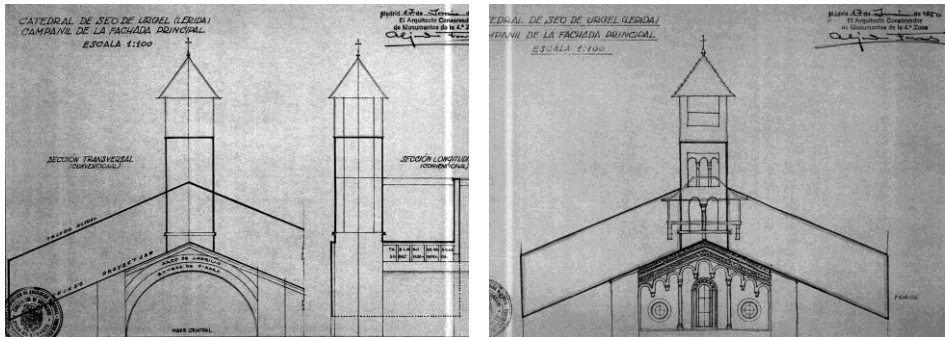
Seo de Urgel. Cathedral de Santa María AAFV. Secciones y alzado del campanil. Planos de proyecto. A. Ferrant
